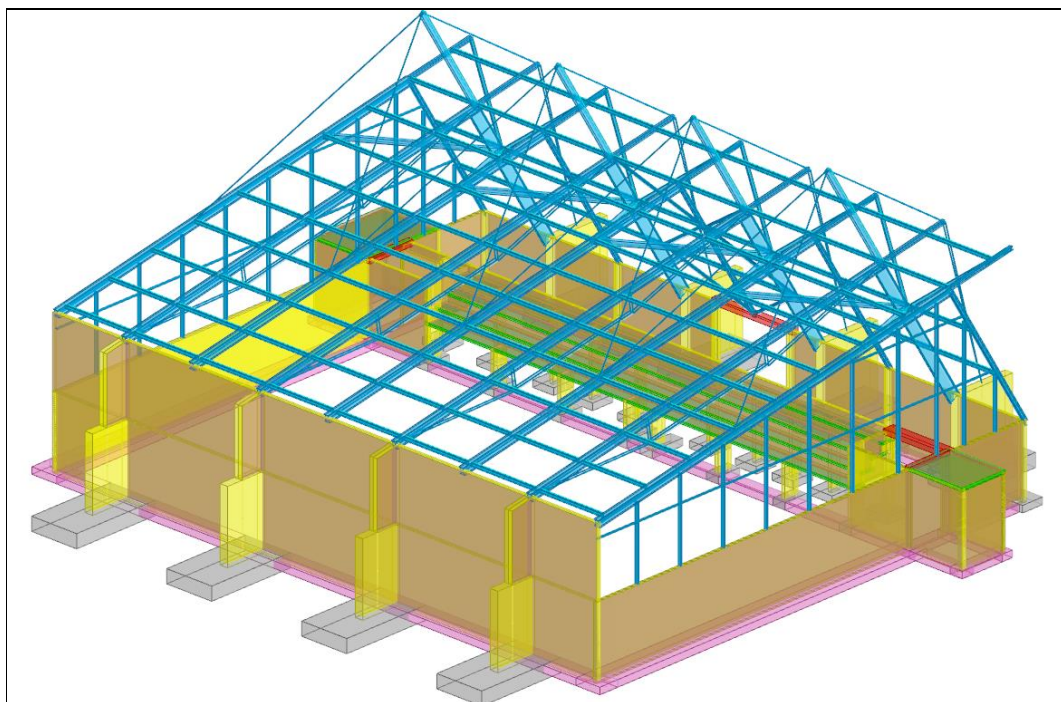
vista del modello FEM (caratteristiche geometriche) – parti in acciaio
